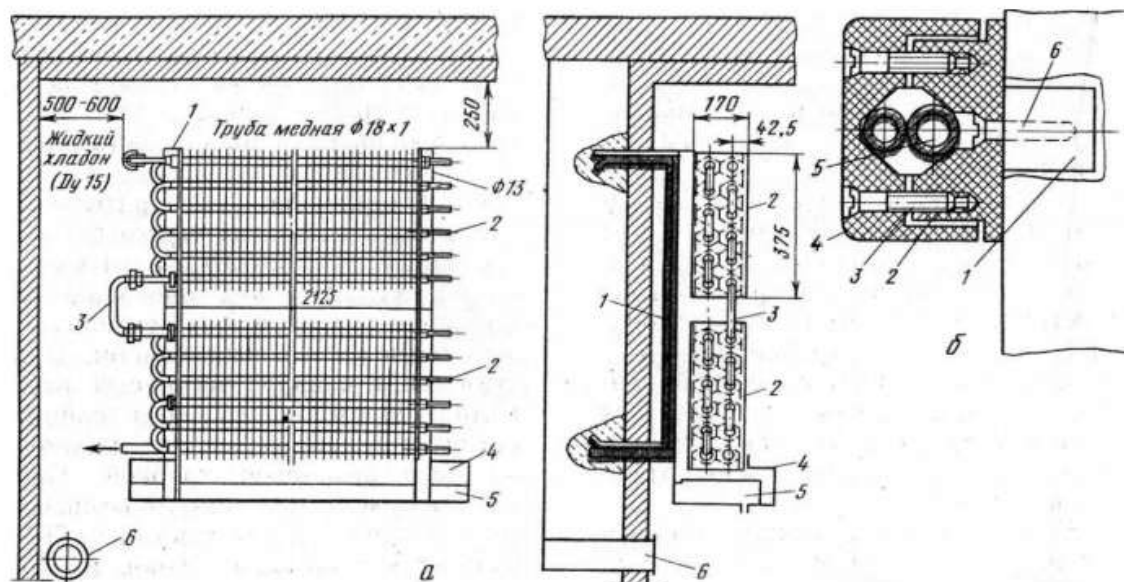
Схема монтажа хладоновых батарей и трубопроводов:
